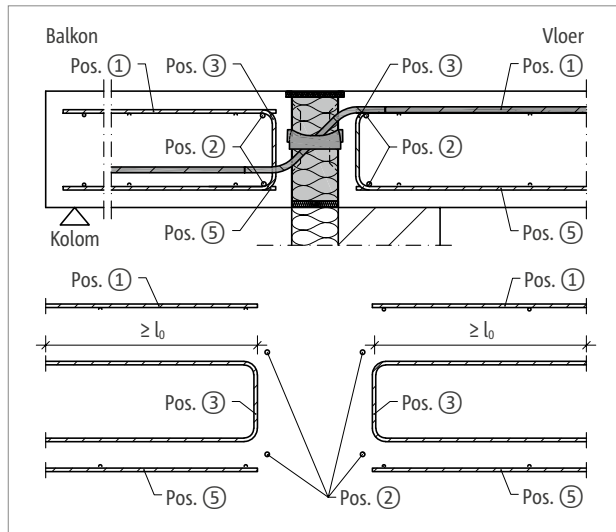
Schöck Isokorf® T type Q-E-VV7: Bovenaanzicht
